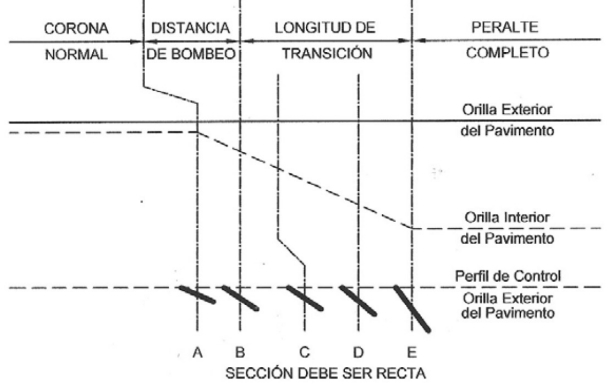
Giro alrededor de la orilla exterior del pavimento.
